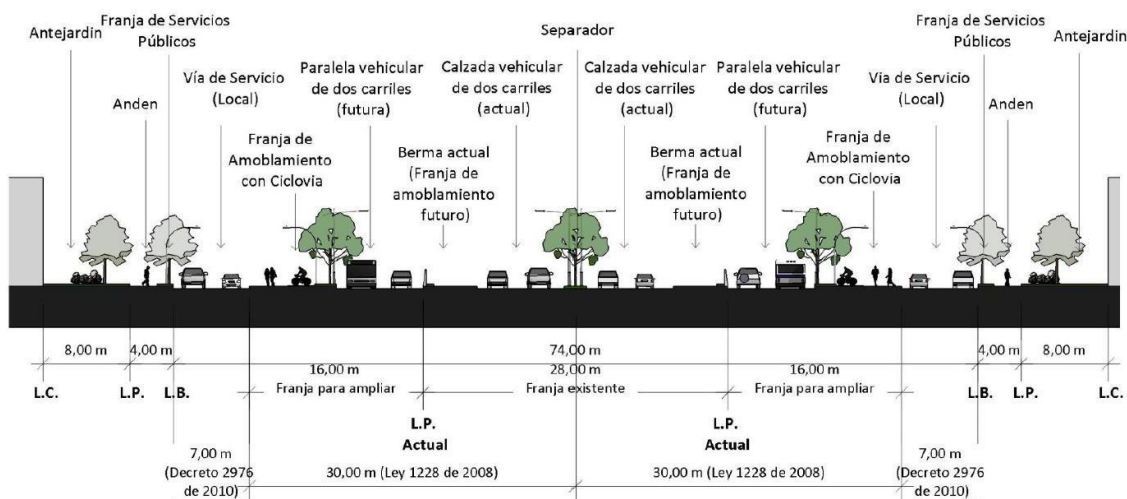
Sección típica perfil V-1. Fuente: POT Barranquilla.
